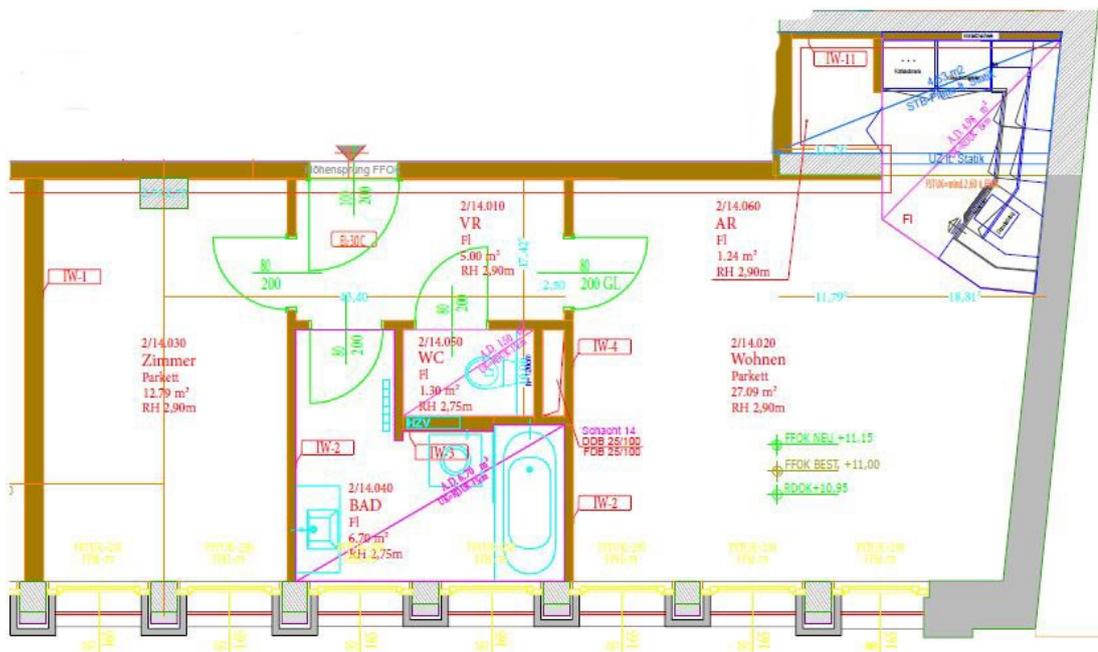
Grundriss Wohnen<sup>75</sup>
